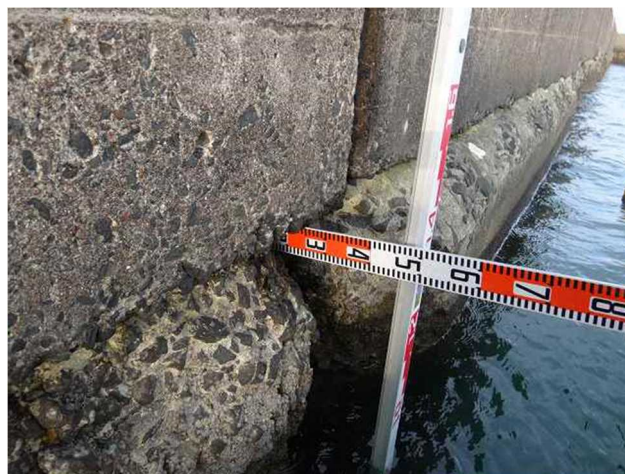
無筋コンクリート防波堤の損耗劣化状況
